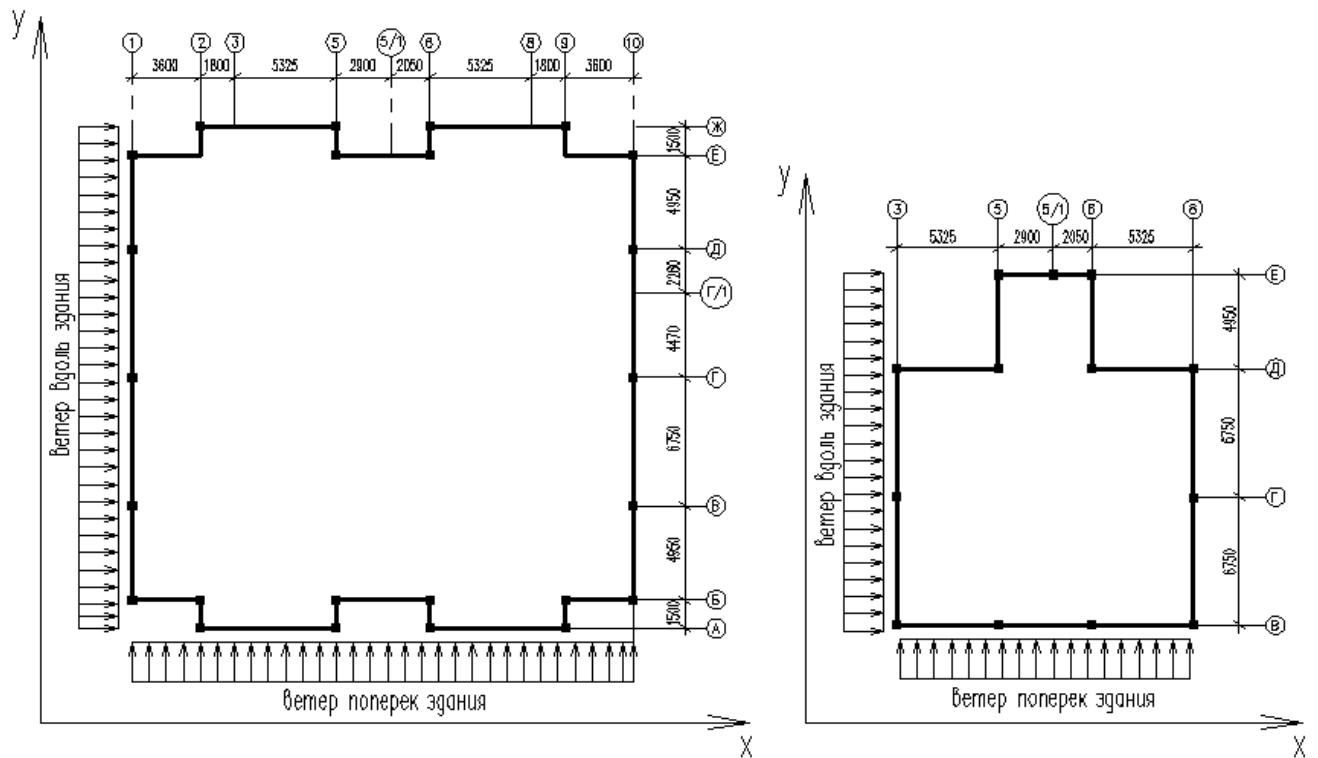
Планы типового и технического этажей (к определению ветровой нагрузки на колонны)
